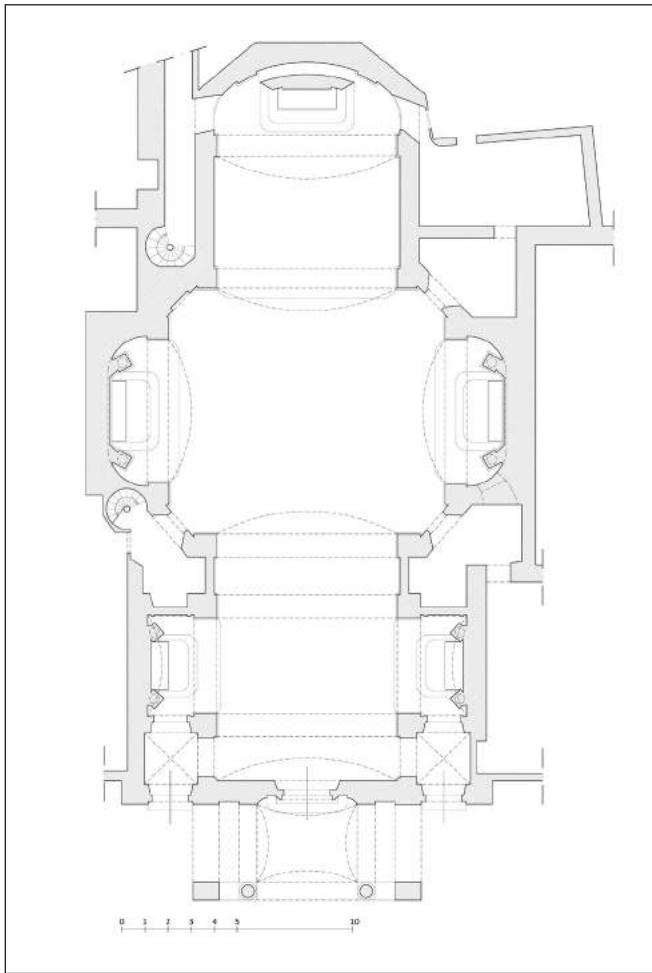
Genova, chiesa della Missione, pianta (rilievo dell'A.).
